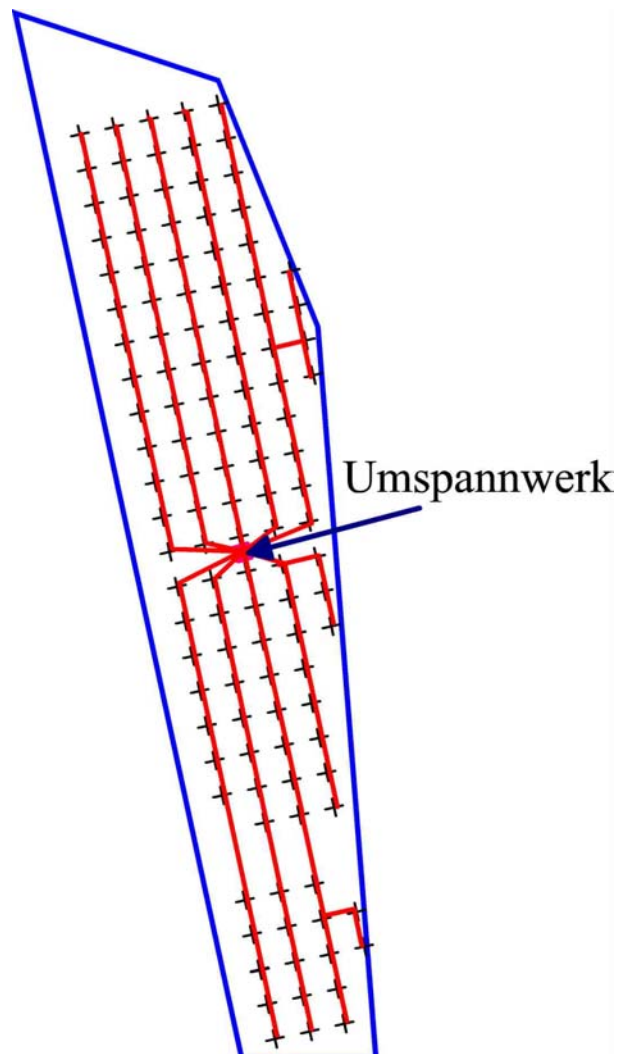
Lageplan der parkinternen Verkabelung und Position des Umspannwerkes.
